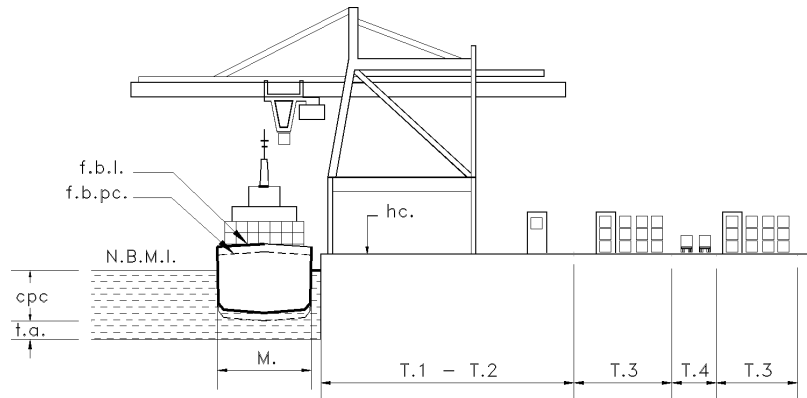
Áreas T.1 y T.2 Sistema de Carretillas - Pórtico
